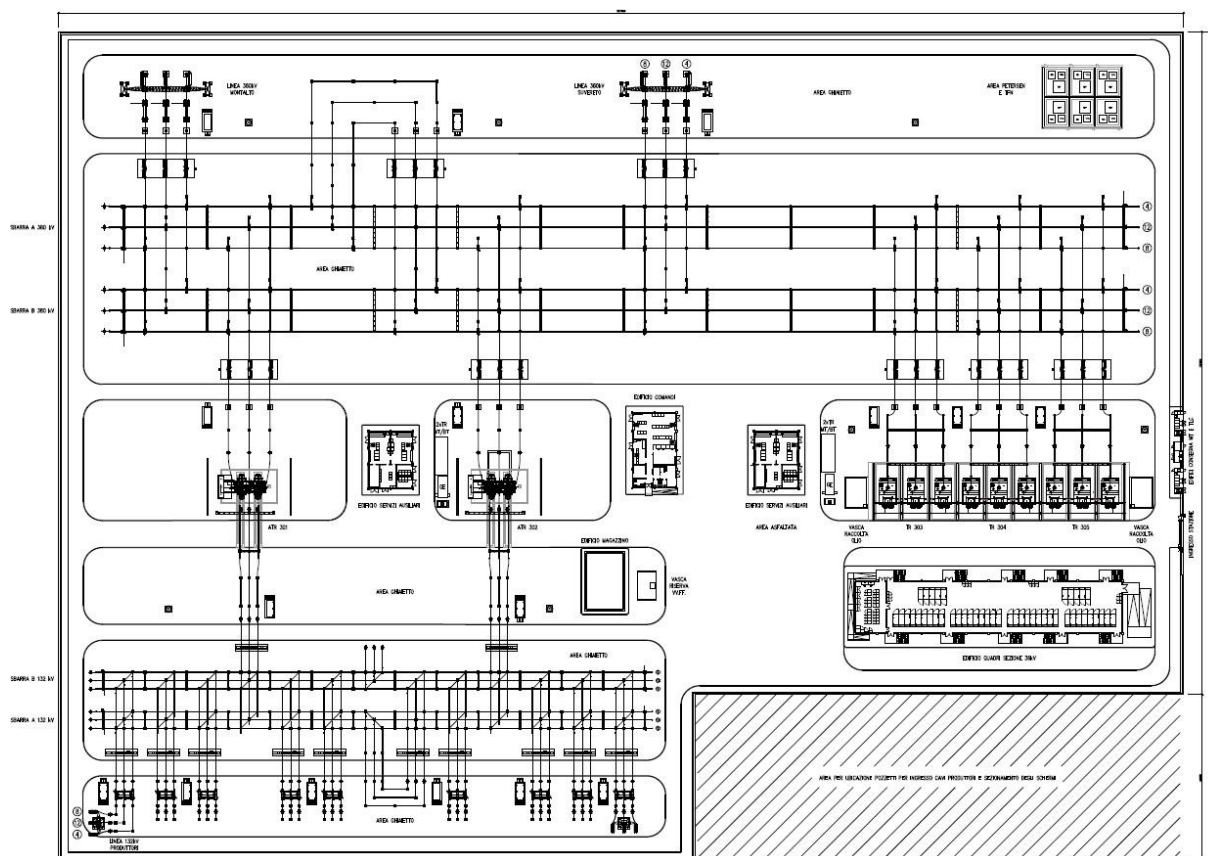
Planimetri della SE Terna 380/132/36 kV di Manciano
